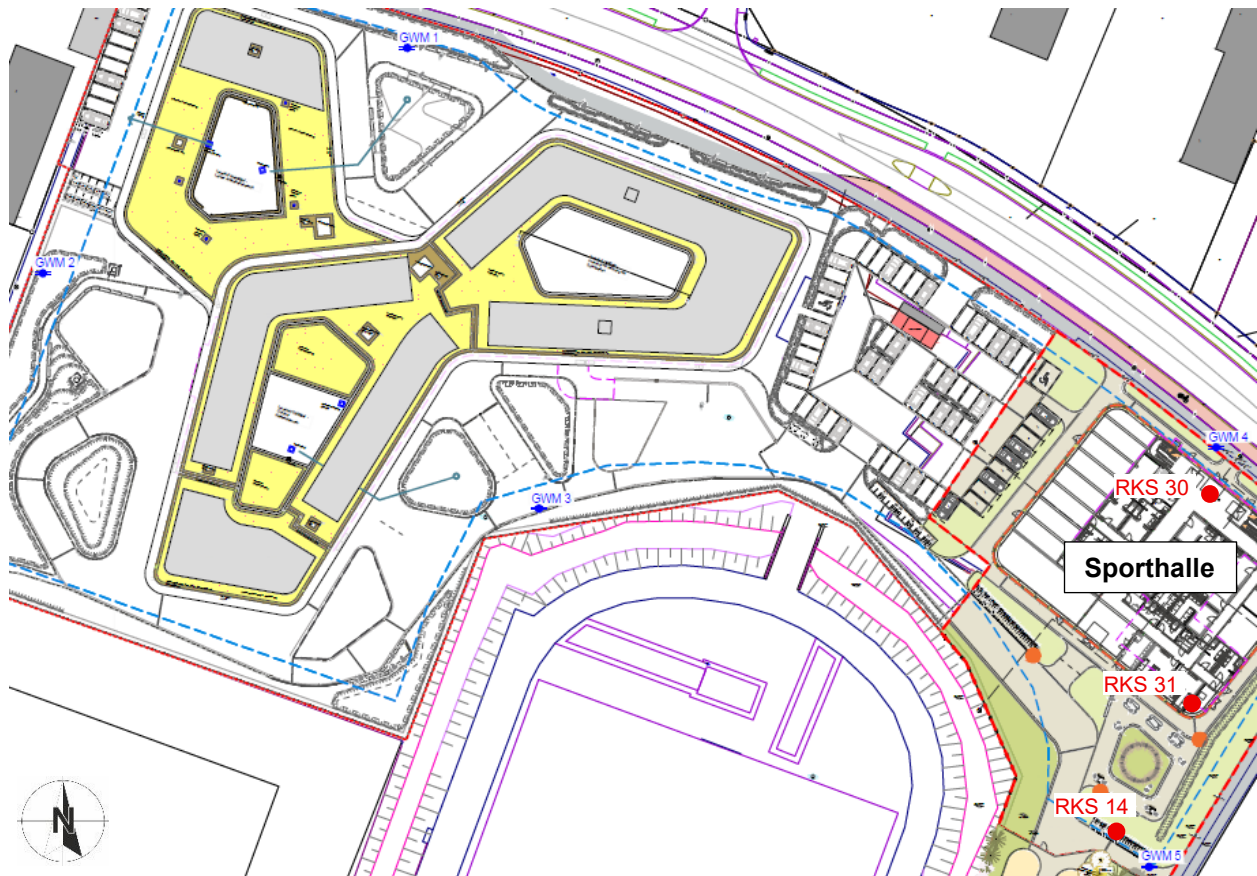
Lageplan der Grundwassermessstellen GWM 1 bis GWM 5 [U2.4] und der RKS 14, RKS 30 und RKS 31 gemäß [U2.1]
